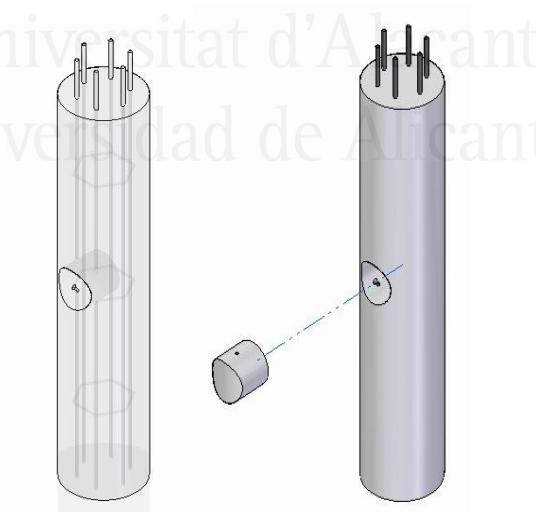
Extracción de testigo en un espécimen tipo soporte de sección circular.
